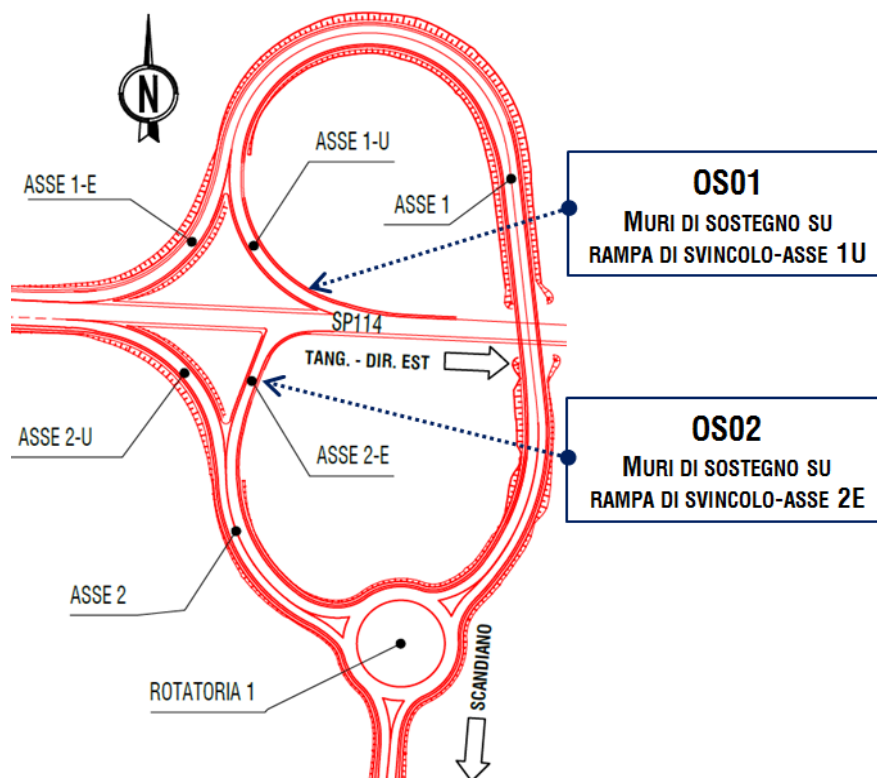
Planimetria generale opere OS01 e OS02.
